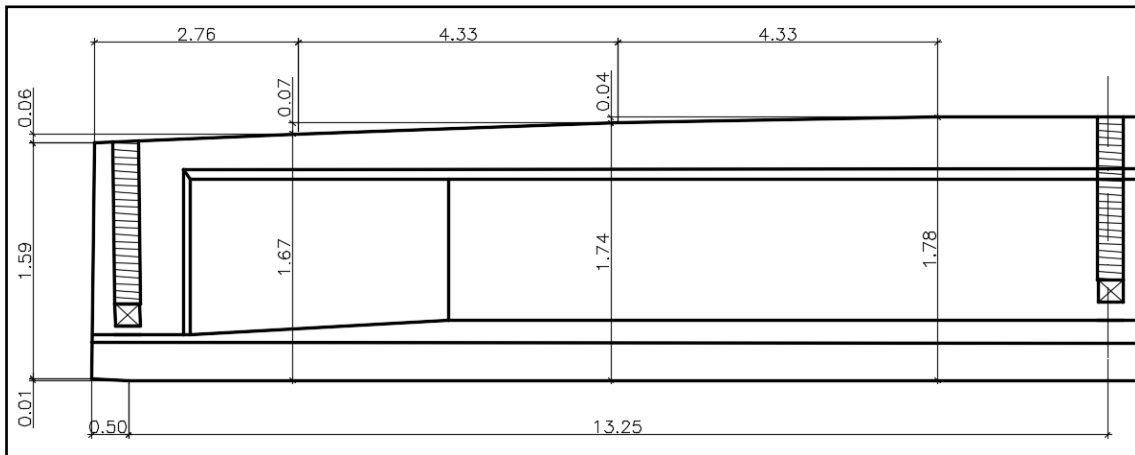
Vista lateral de la viga pretensada hasta sección central, con escala vertical aumentada.
